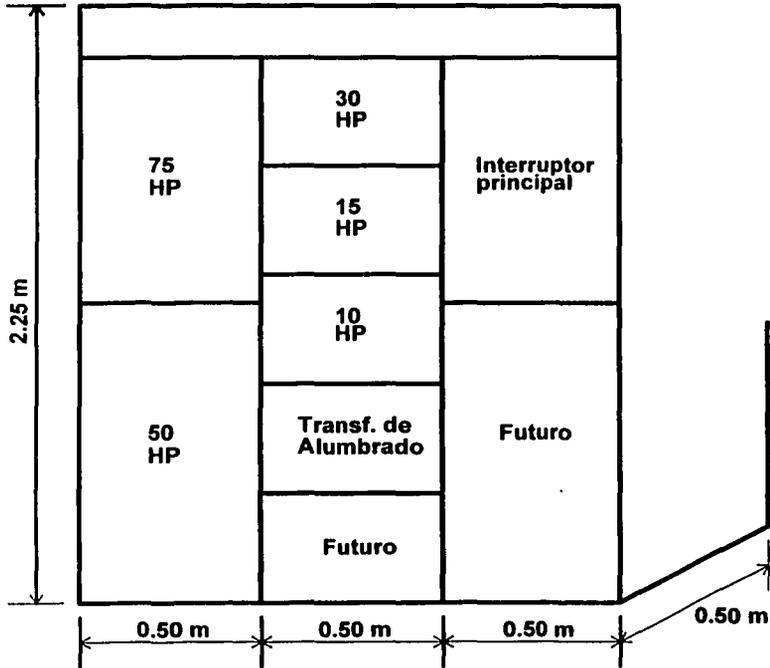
DISPOSICIÓN Y DIMENSIONES GENERALES DE UN CCM
